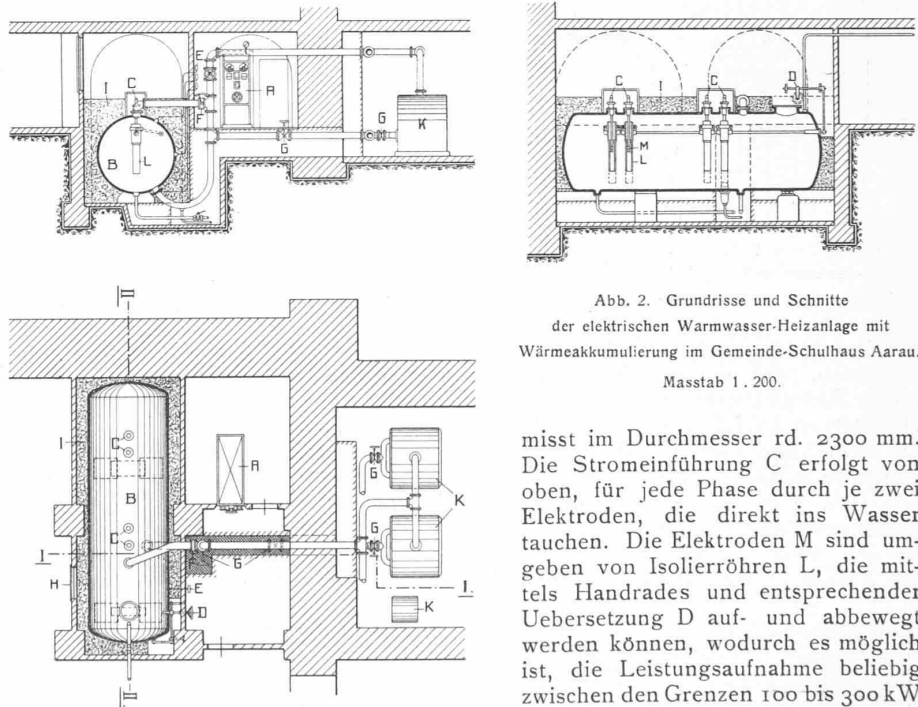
Grundrisse und Schnitte der elektrischen Warmwasser-Heizanlage mit Wärmeakkumulierung im Gemeindeschulhaus Aarau. Masstab 1:200.
